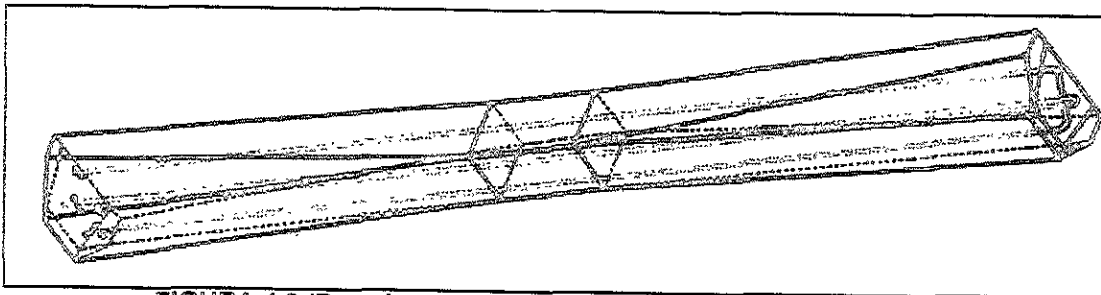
(Durmiente monolítico de concreto presforzado)
